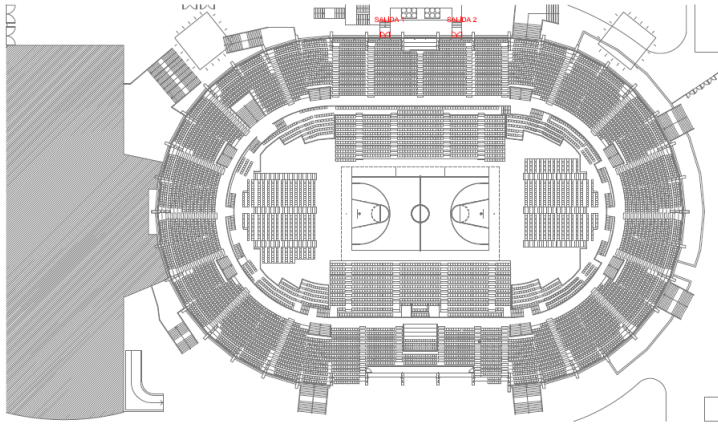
Plano Planta cota 9,30. Plano de Planta 5.
